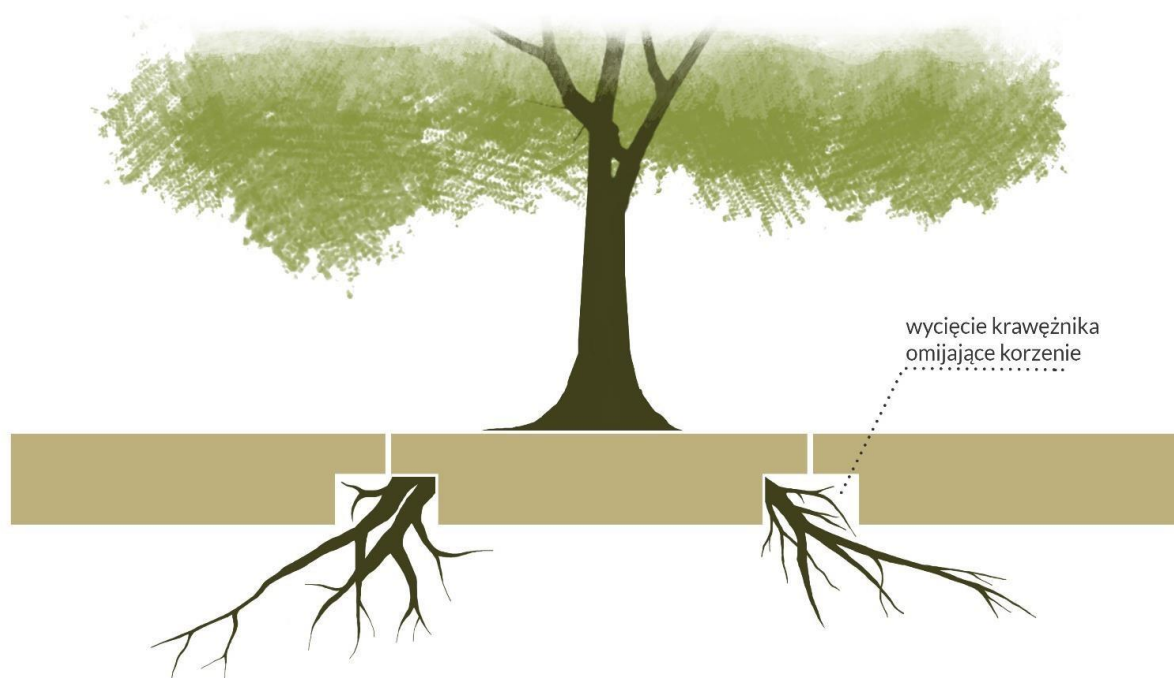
Przykład konstrukcji chodnika podwieszanego.
